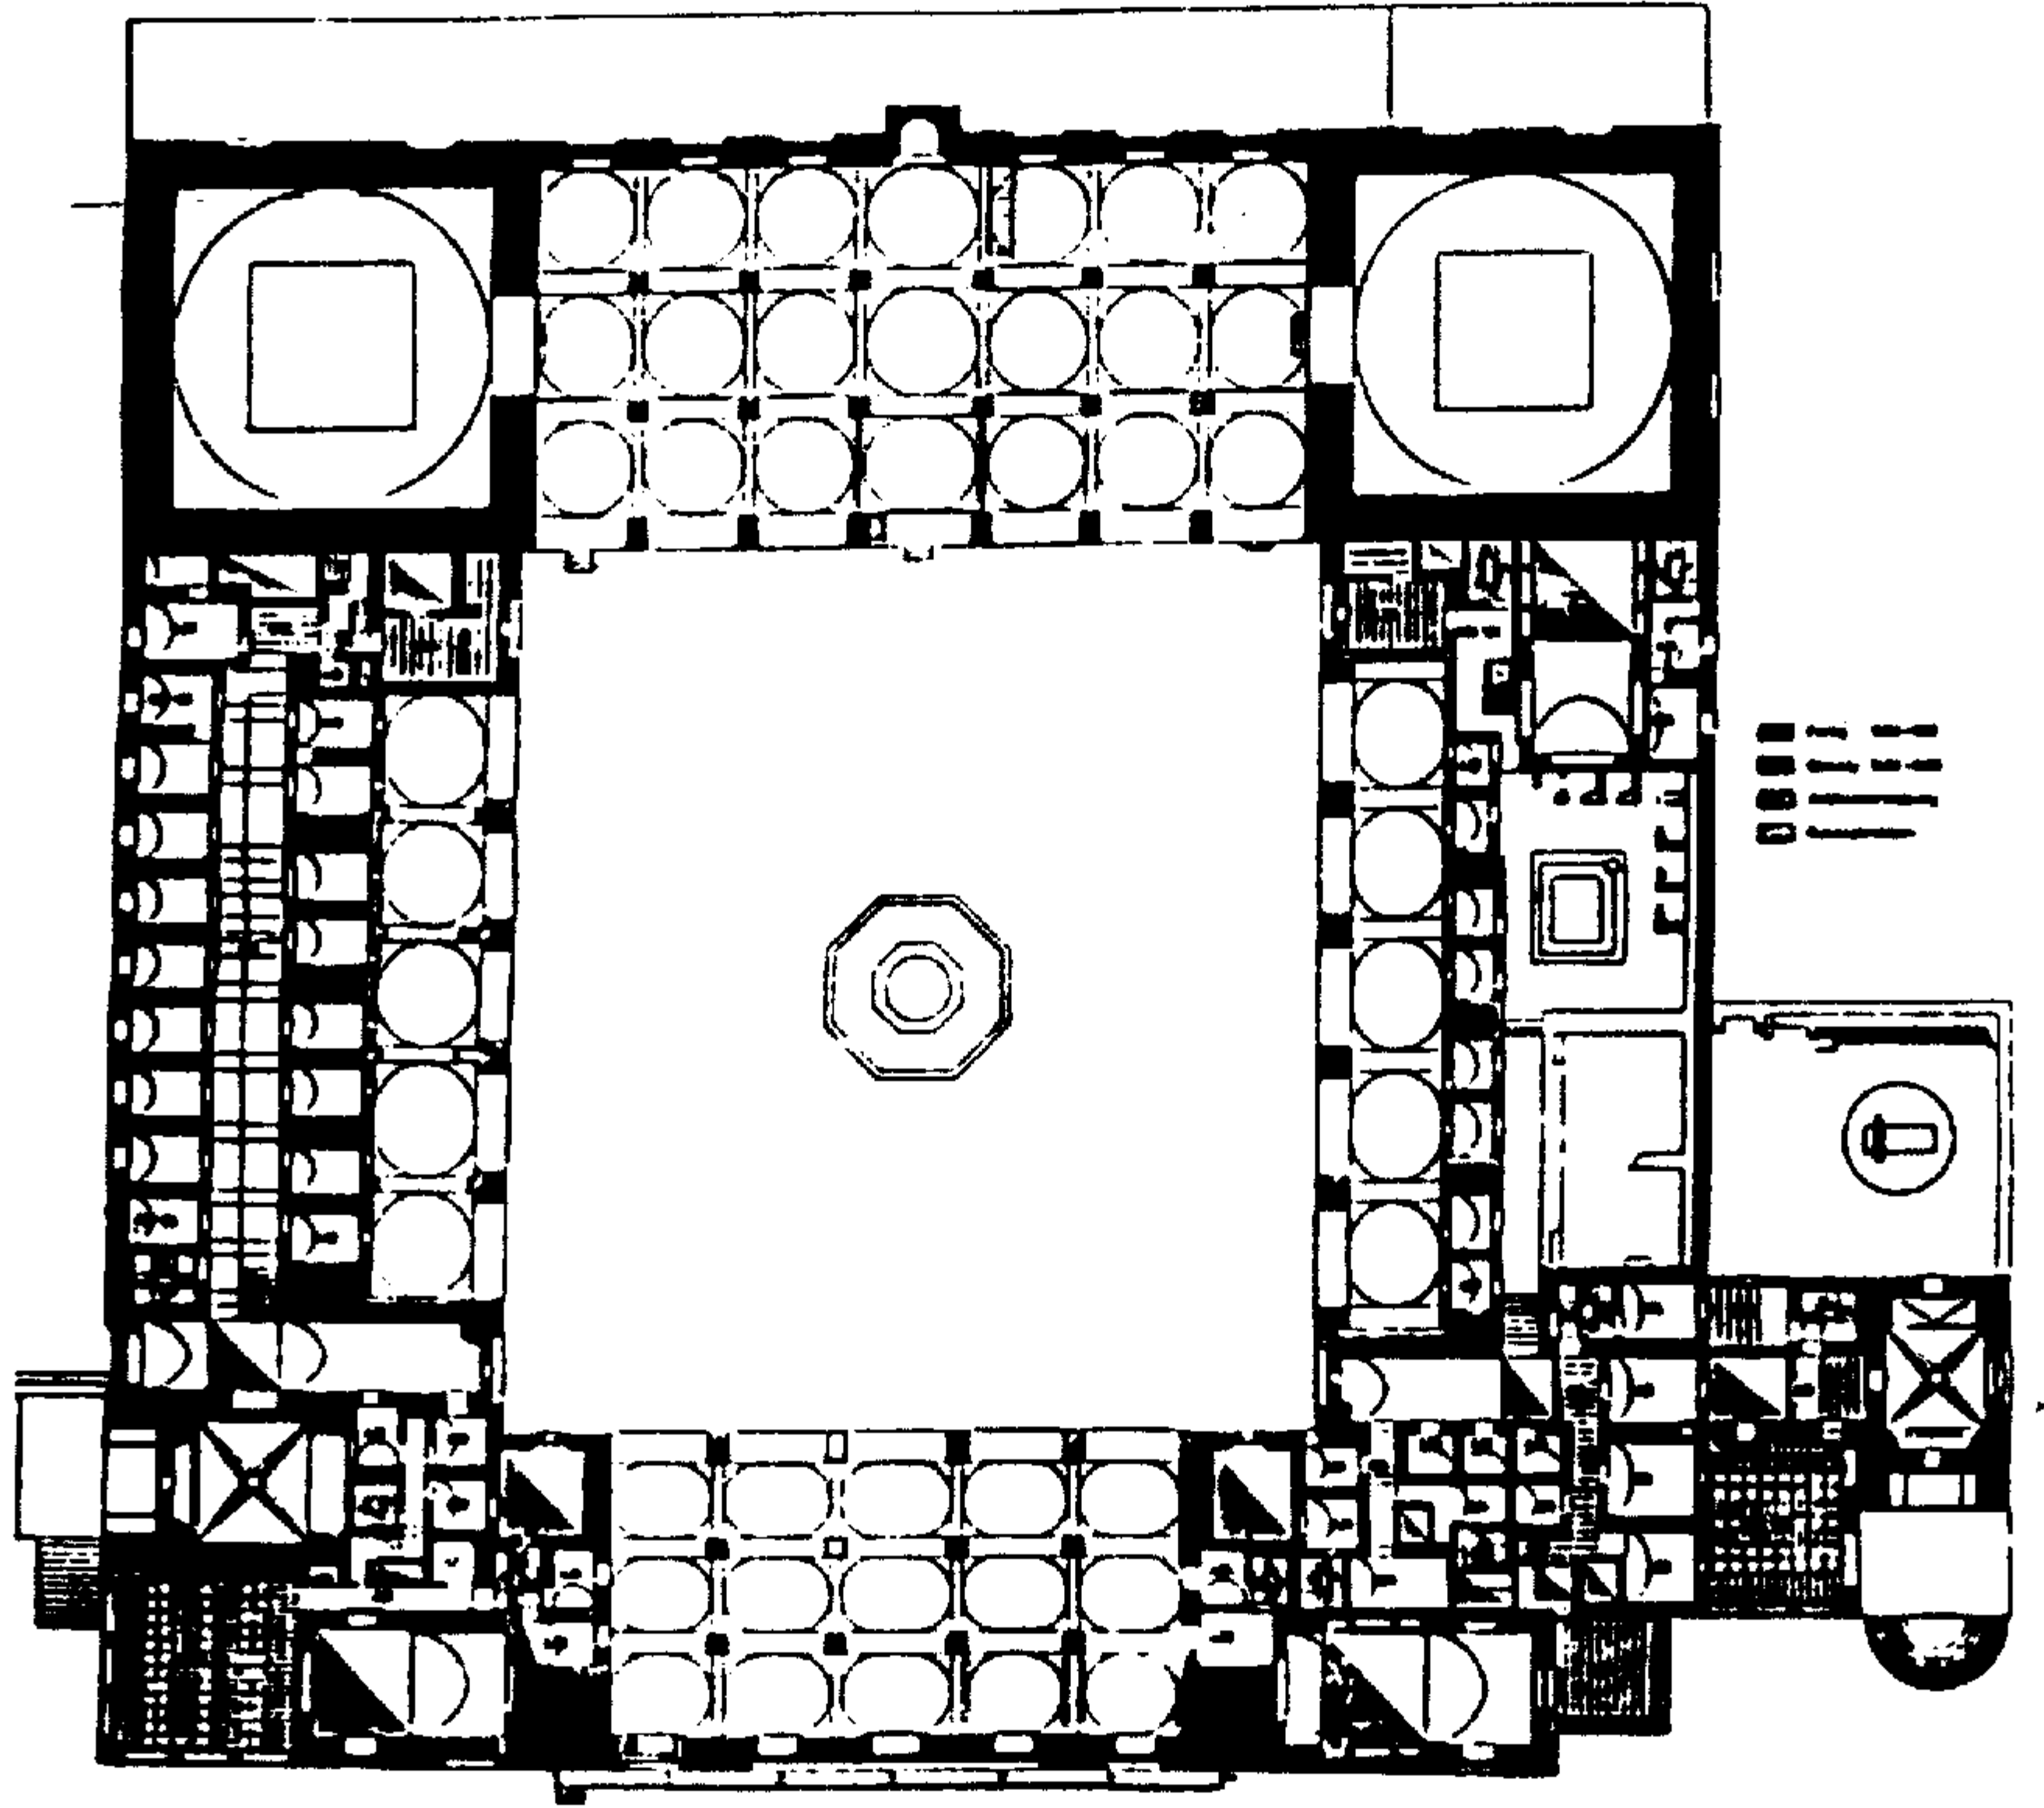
مسقط أفقي لمدرسة صرغمال بقونين.
